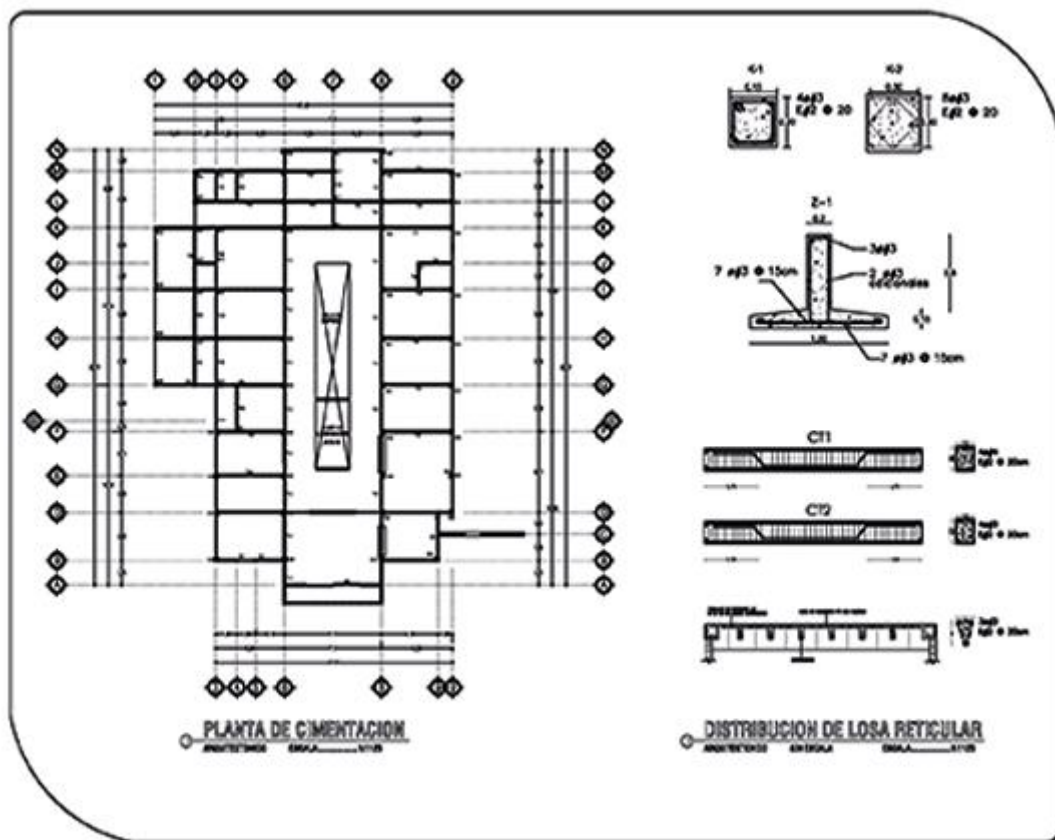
PLANO ESTRUCTURAL 1 DE 3. DETALLES DE CIMENTACIÓN
